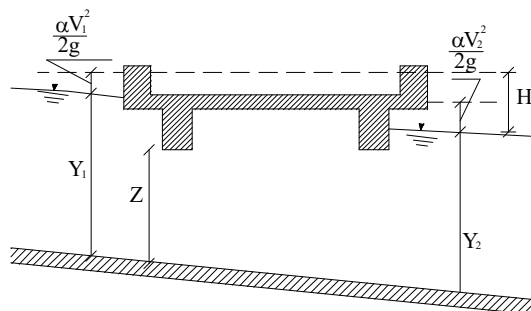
Sezione schematica di un ponte – Schema di calcolo
